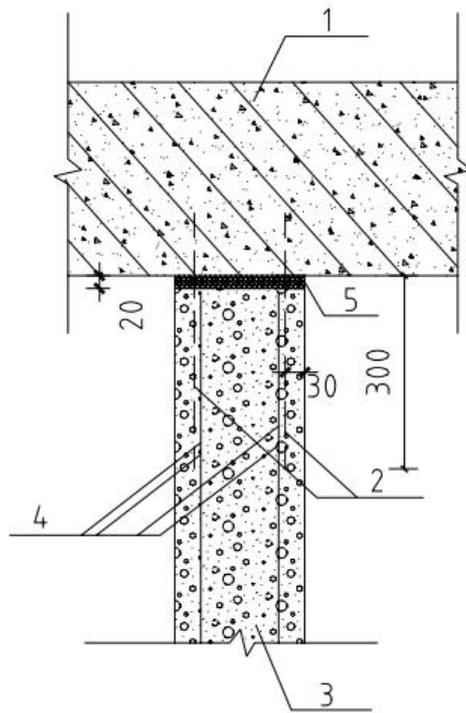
配双层钢丝焊接网的泡沫混凝土墙顶与梁（板）连接示意
